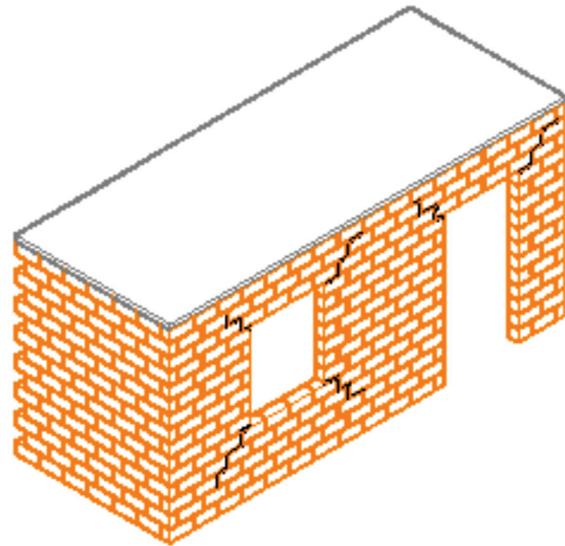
Fissuras por falta de vergas e contravergas.
